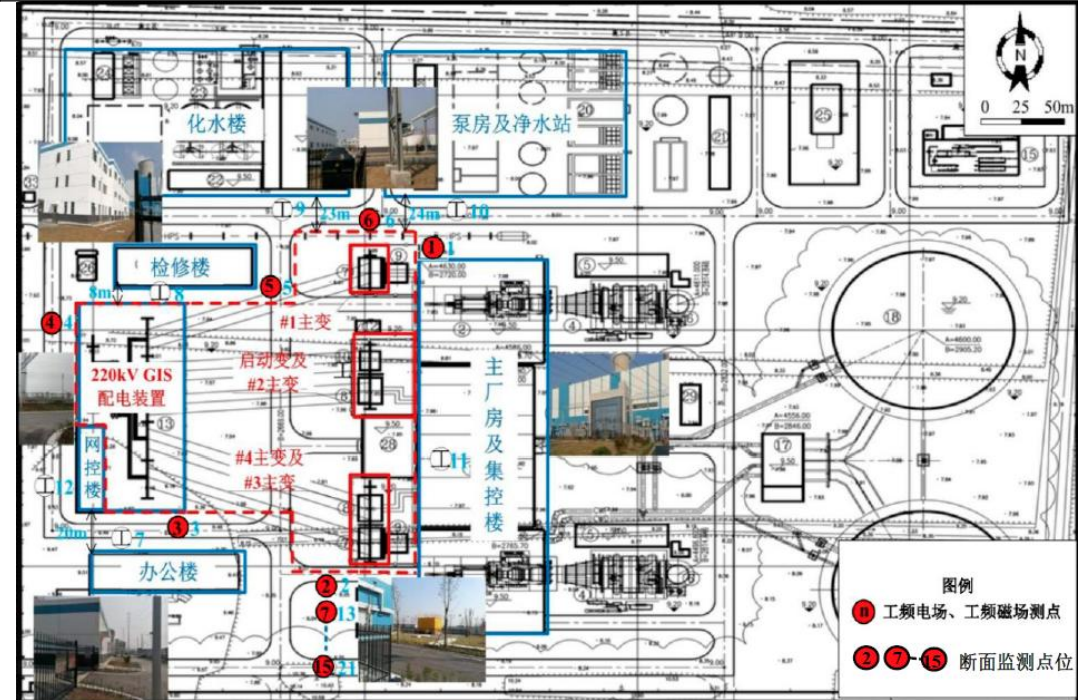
类比升压站站址周围监测布点及平面布置示意图
